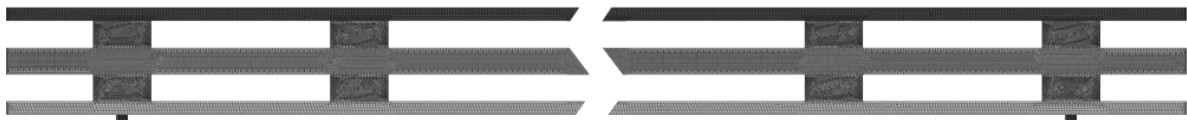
Exemple de maillage d'une poutre ajourée
